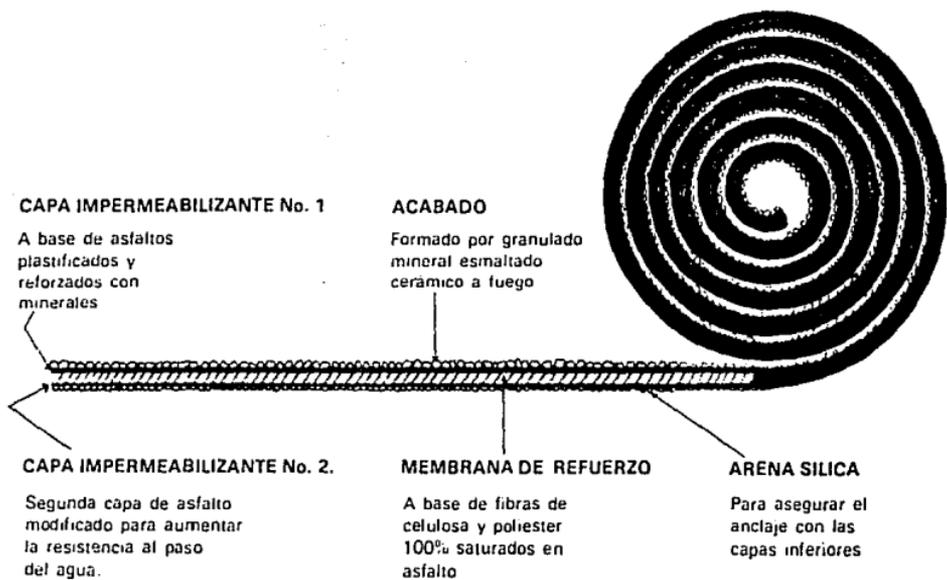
Esquema de un impermeabilizante prefabricado
